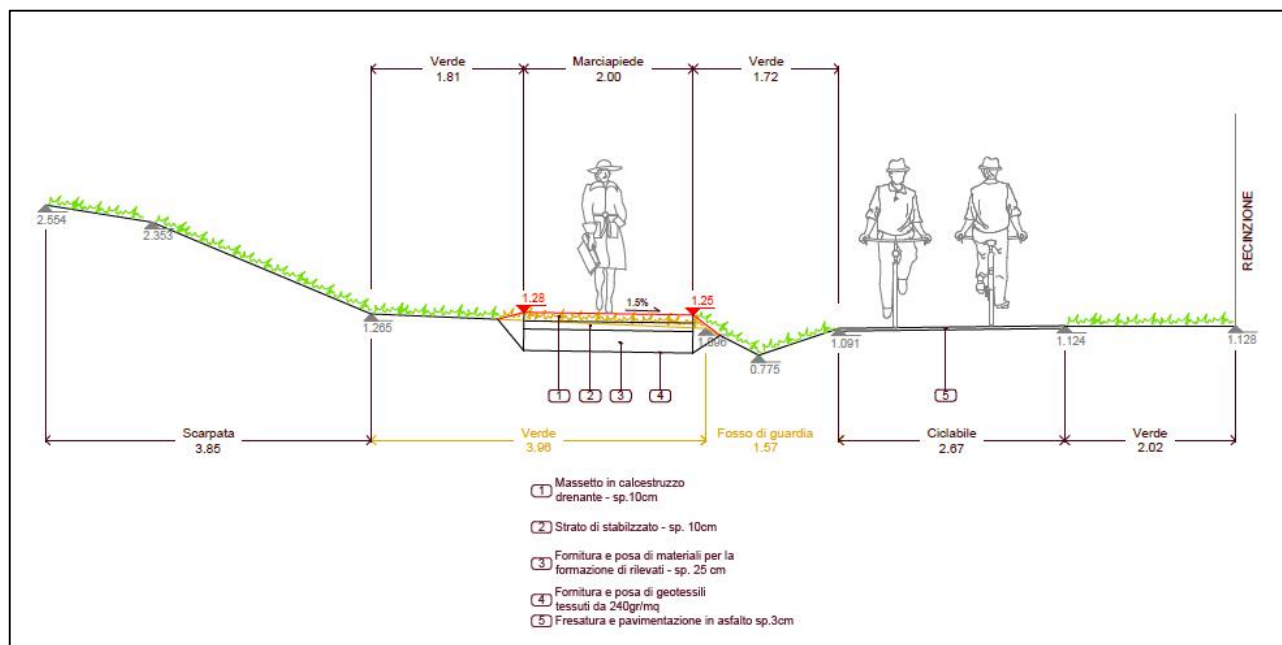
Sezione 17 di progetto trasversale SP delle Collacchie
